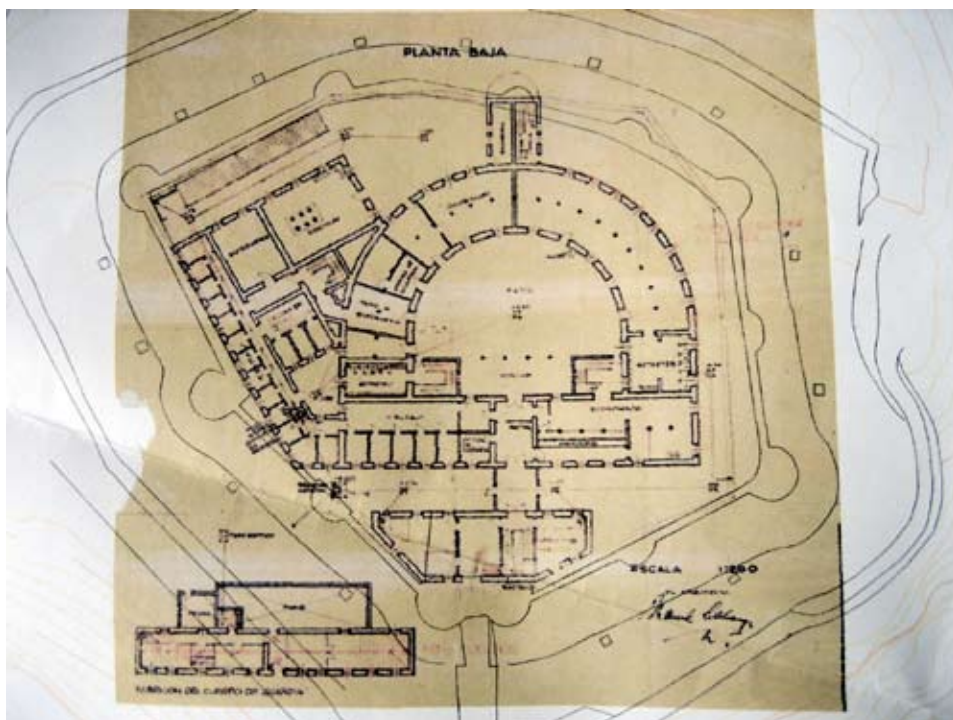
Planta del penal chinchillano sobre el recinto fortificado.
